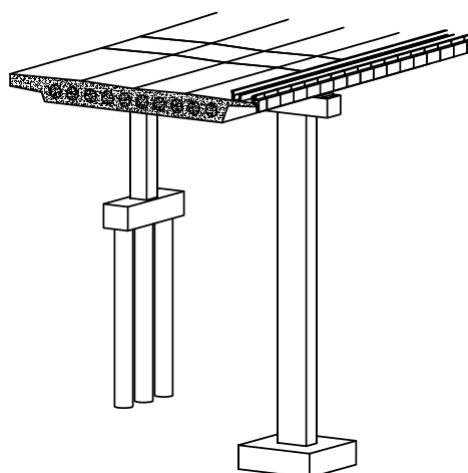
Vista de um alinhamento de pilares dotado de travessa (imagem retirada do modelo BIM)
